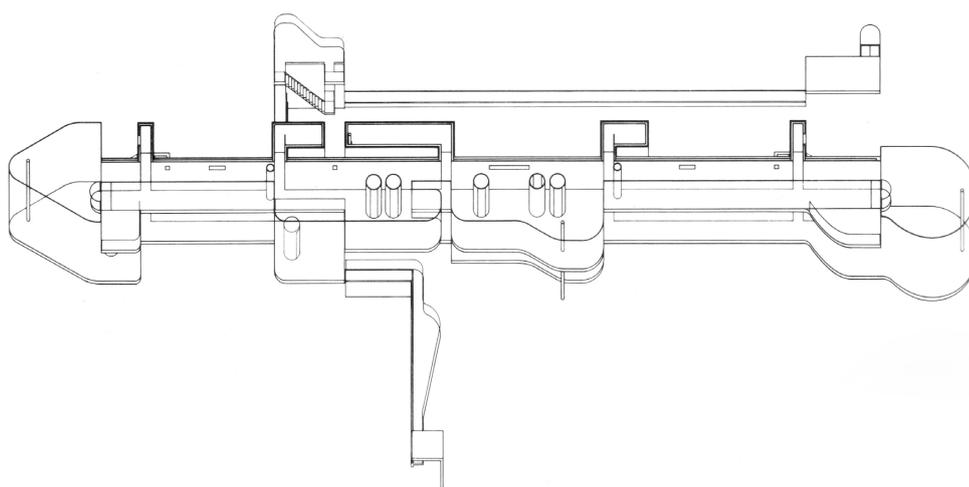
James Amatzuzzo. *House* (1968-1969). Planta Baixa pav. inferior.
